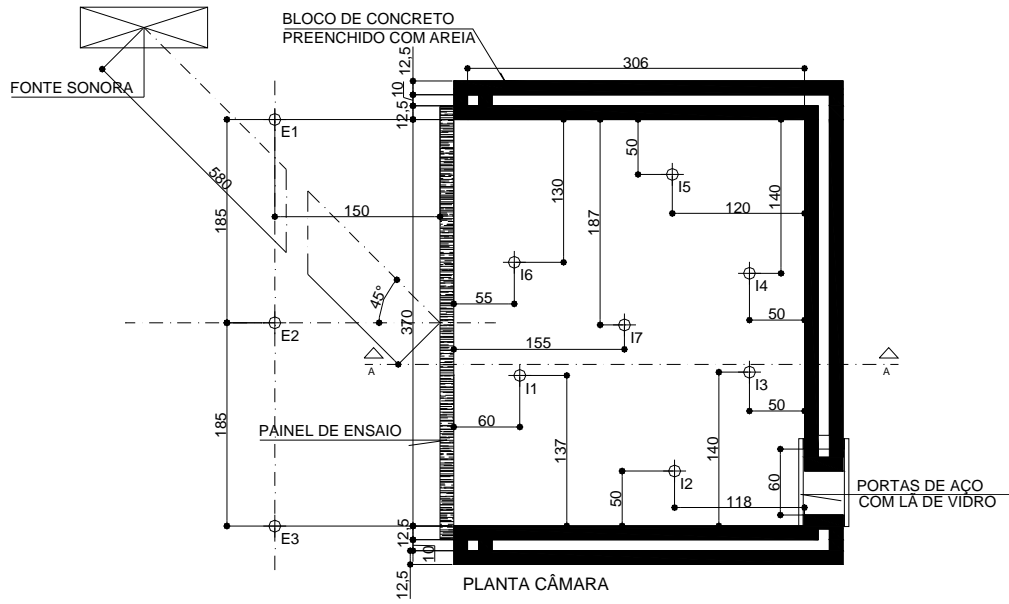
Planta da câmara de ensaio II (unidades em centímetros)
